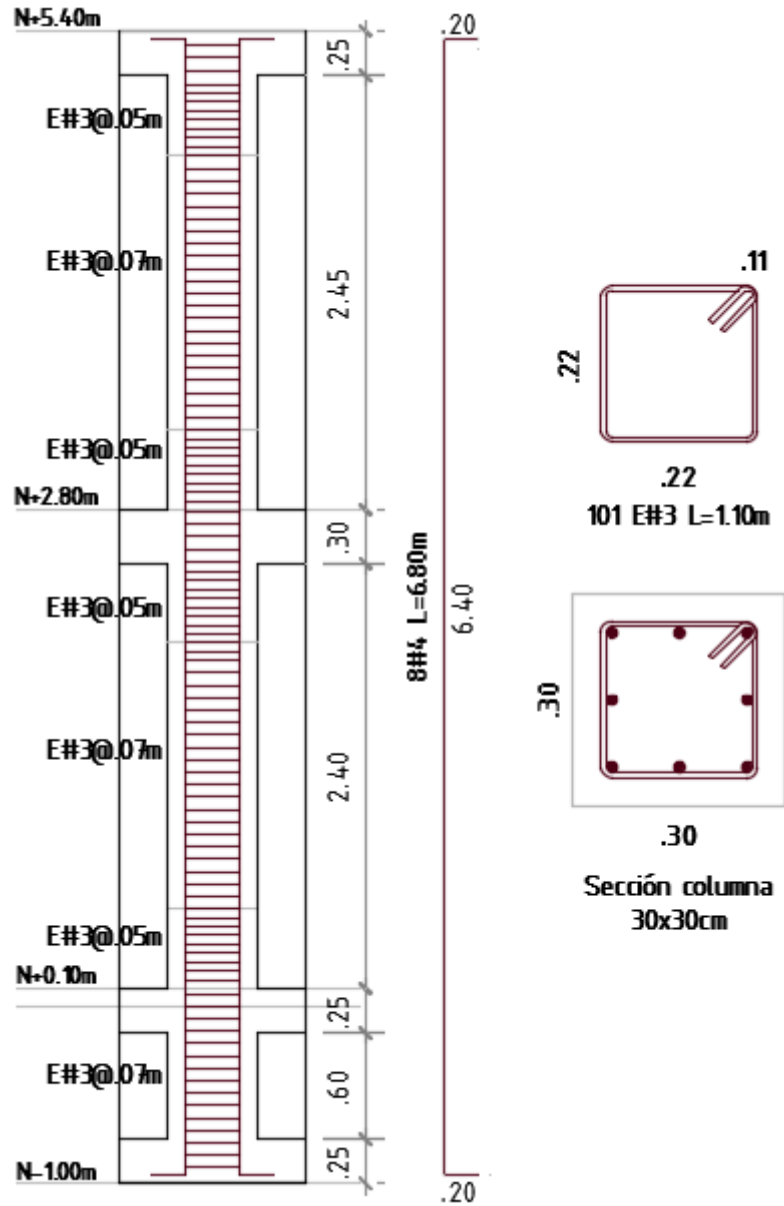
Detalle de columna típica en sistema tipo pórtico de dos pisos
